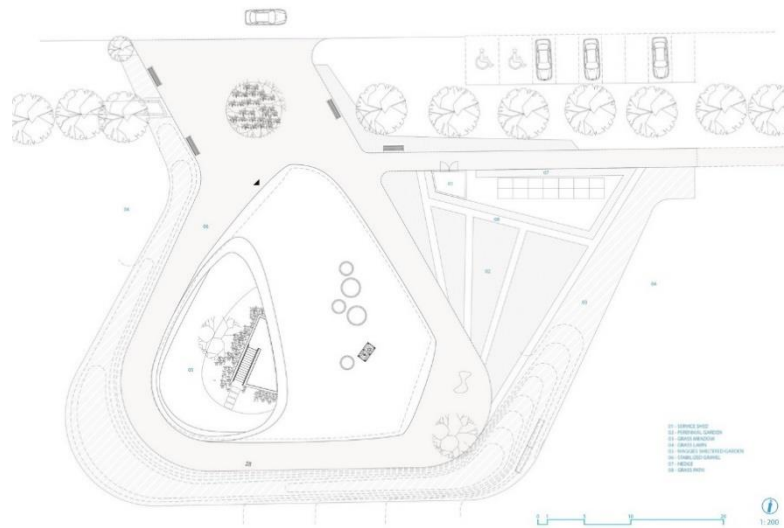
17 Maggies Cancer Caring Center 1st Floor Plan
